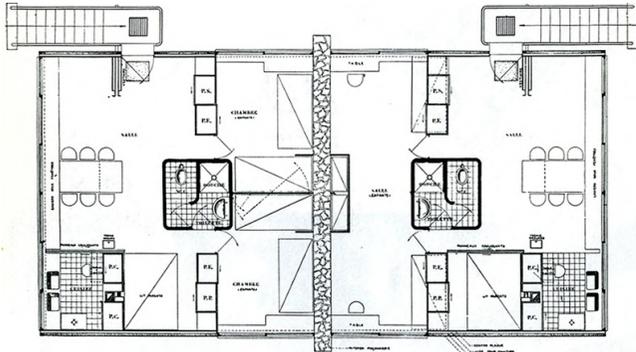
30: Planta de Maison Loucheur (Uso Hard, Viviendas de día y de noche).
